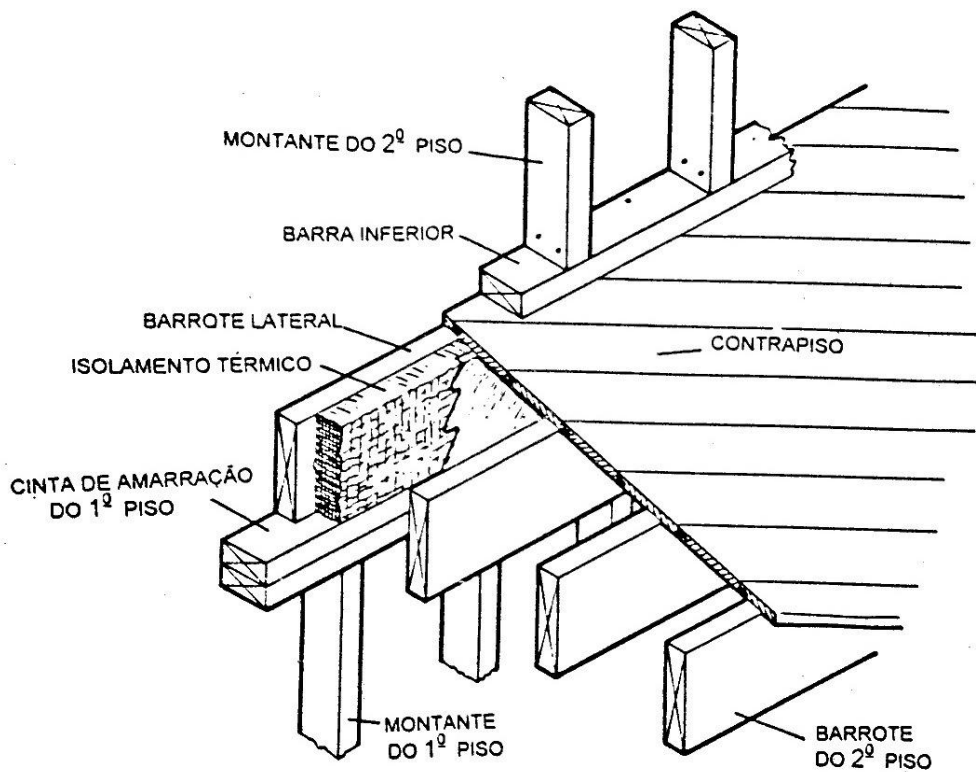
Detalhe construtivo do segundo pavimento no sistema plataforma
